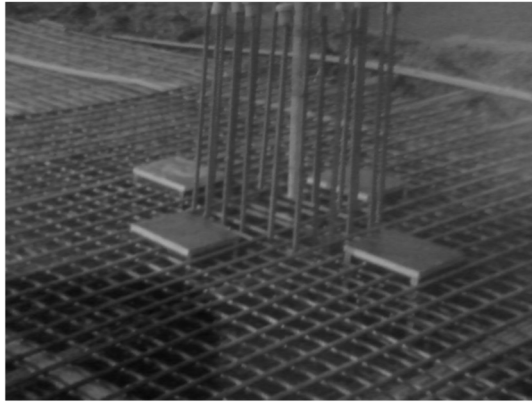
Barras da armadura negativa seccionadas para permitir execução de furos.
